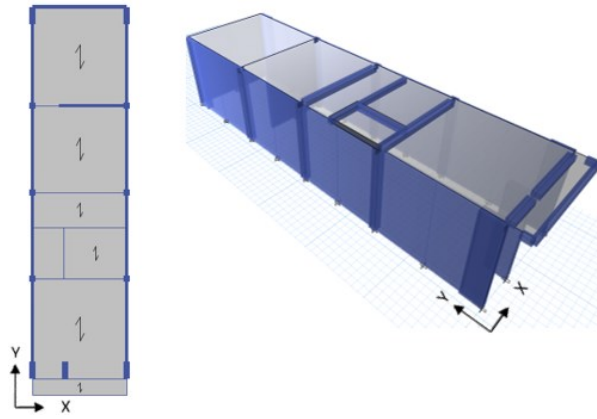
Vista en planta y 3D, tipología GII(1P) – ETABS.
